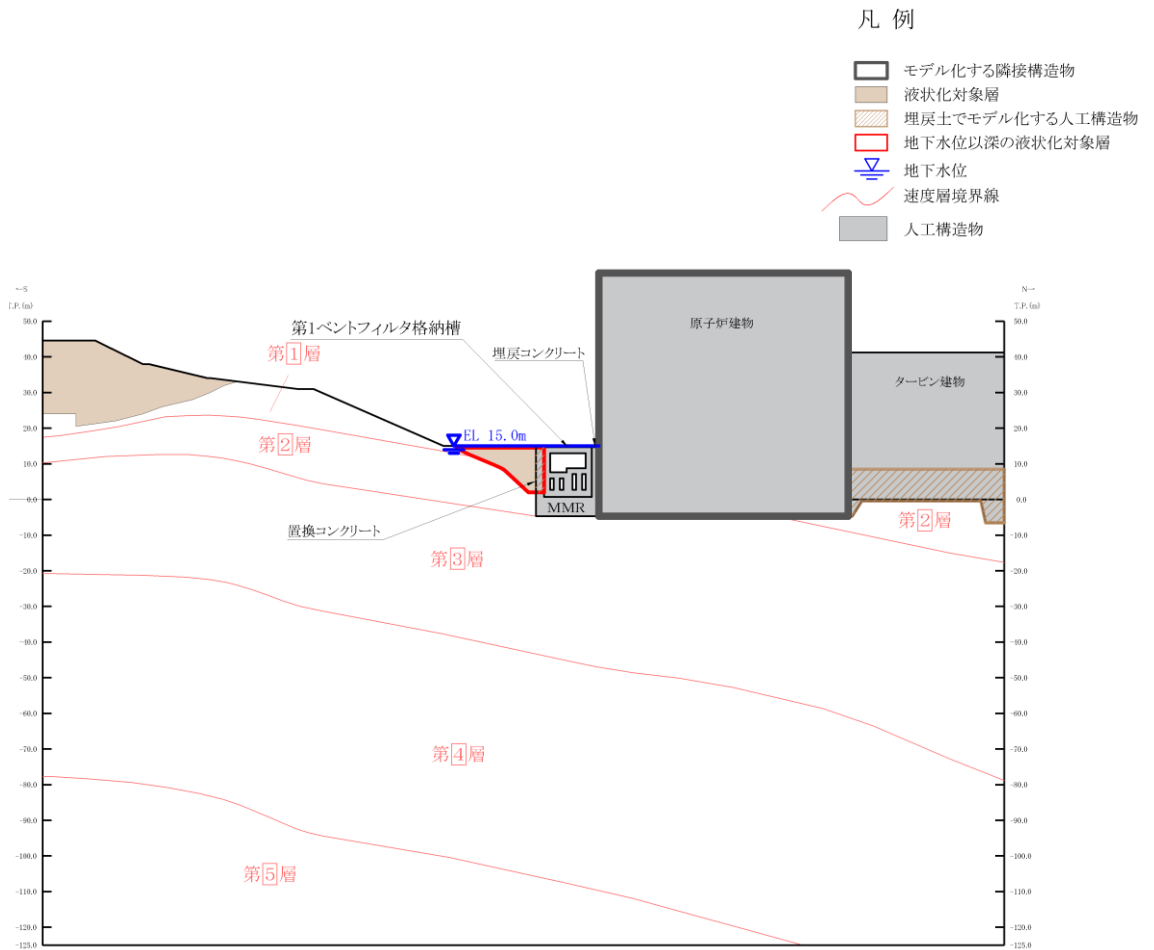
第 1 ベントフィルタ格納槽 評価対象断面図 (B-B 断面)
